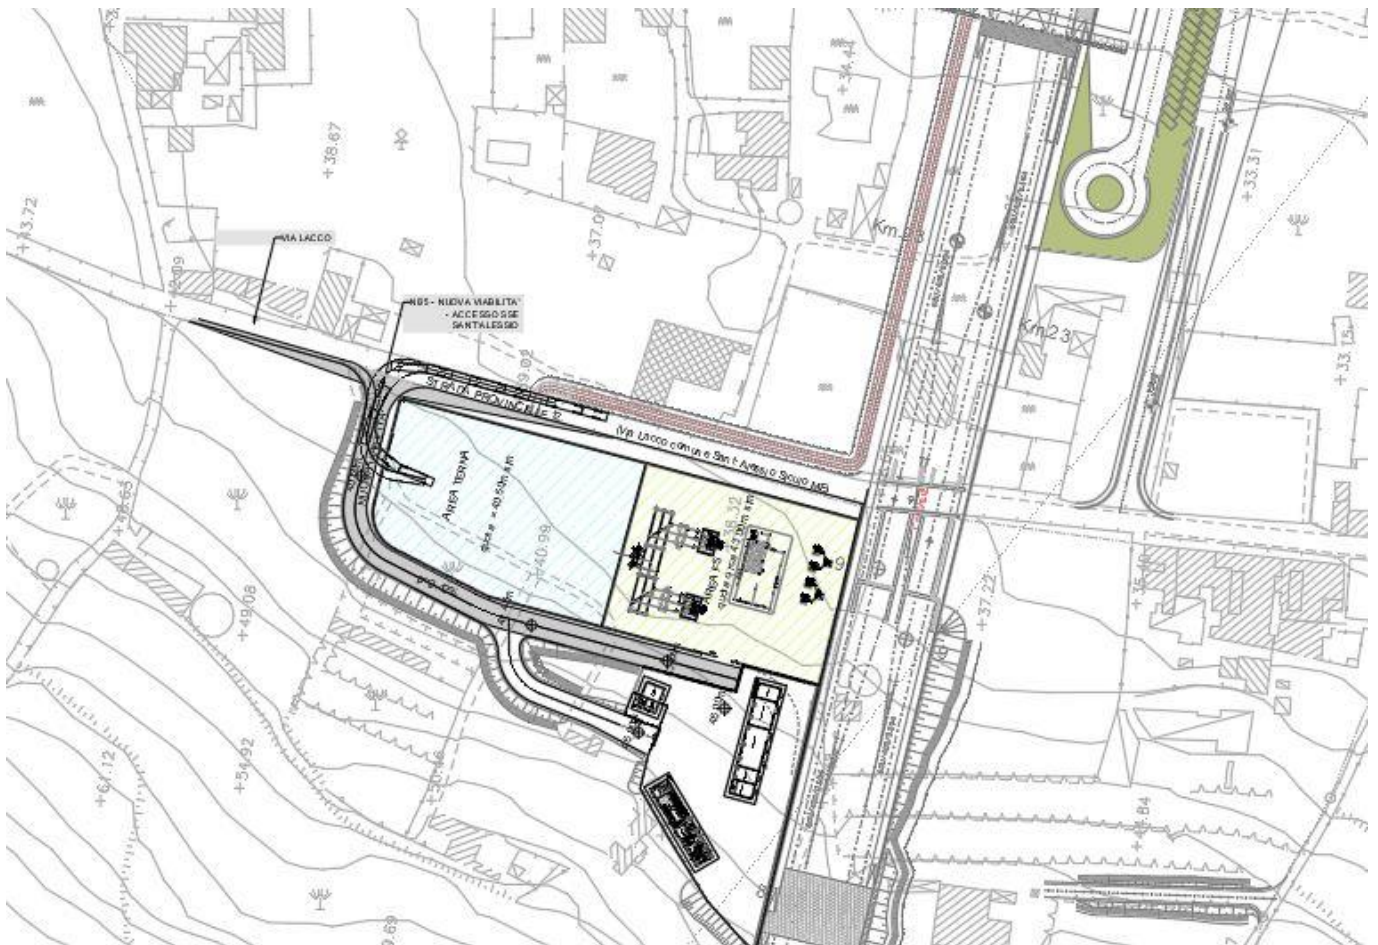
Stralcio planimetria SSE Sant'Alessio Siculo (MS)
